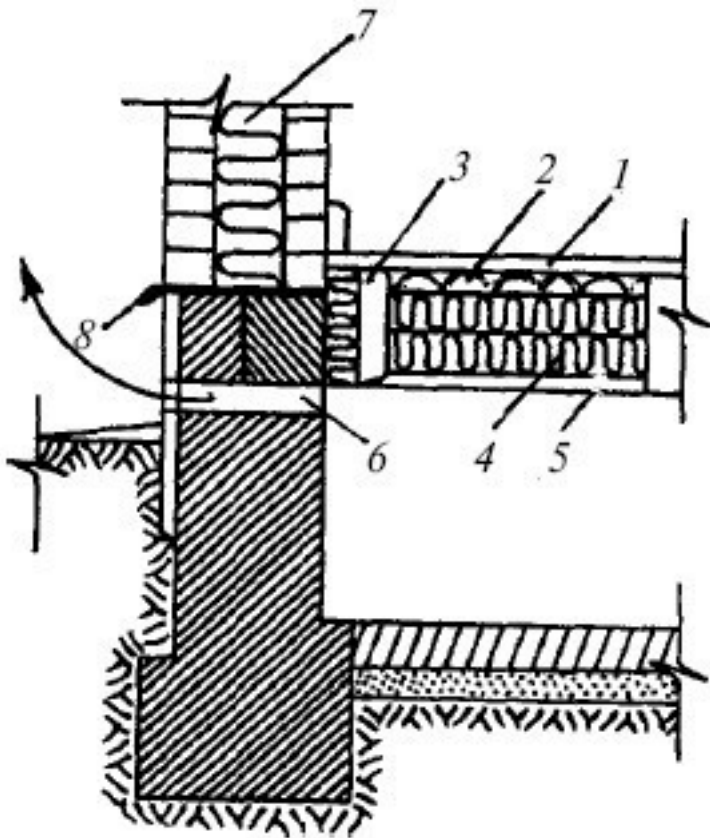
Утепление перекрытия над подвалом теплоизоляционными плитами ЛАЙТ БАТТС: 1 – пол; 2 – пароизоляция; 3 – балки, опирающиеся на цоколь или стены подвала; 4 – плиты ЛАЙТ БАТТС; 5 – подшивка из досок; 6 – венти-
